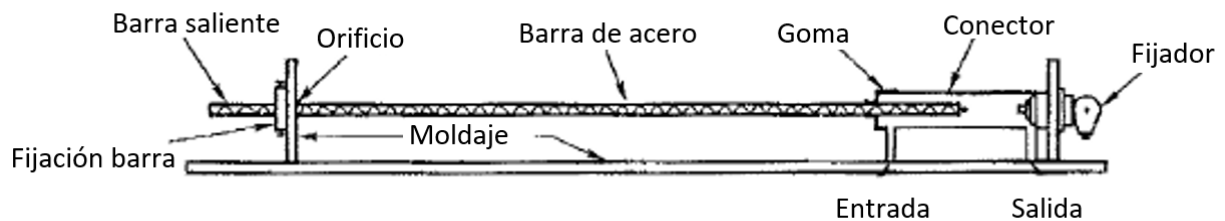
Esquema de conector con barra en moldaje. (Ref. 10)
